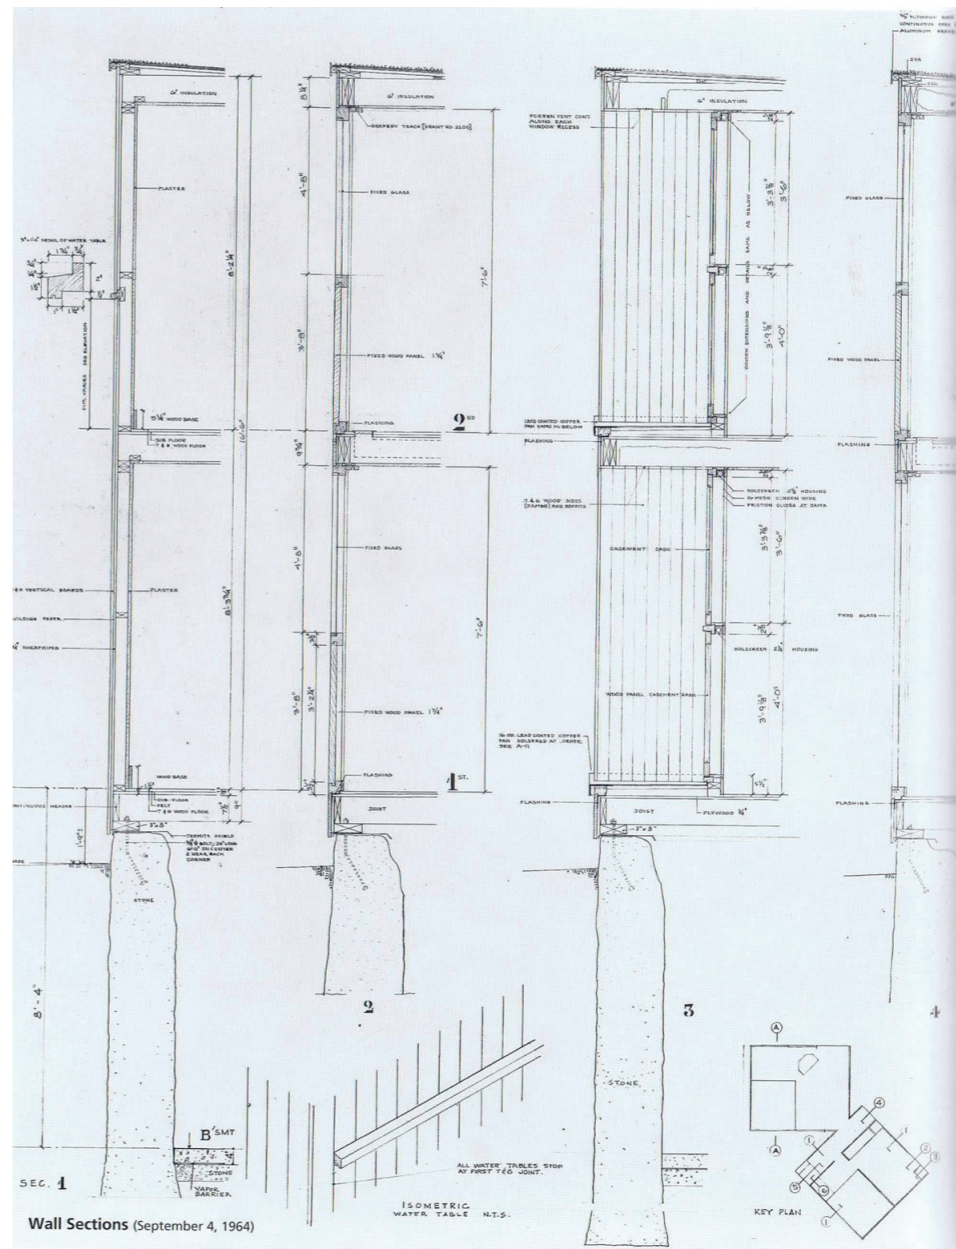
Plano de sección constructiva original ejecutado por Kahn el proyecto de la Fisher House.
